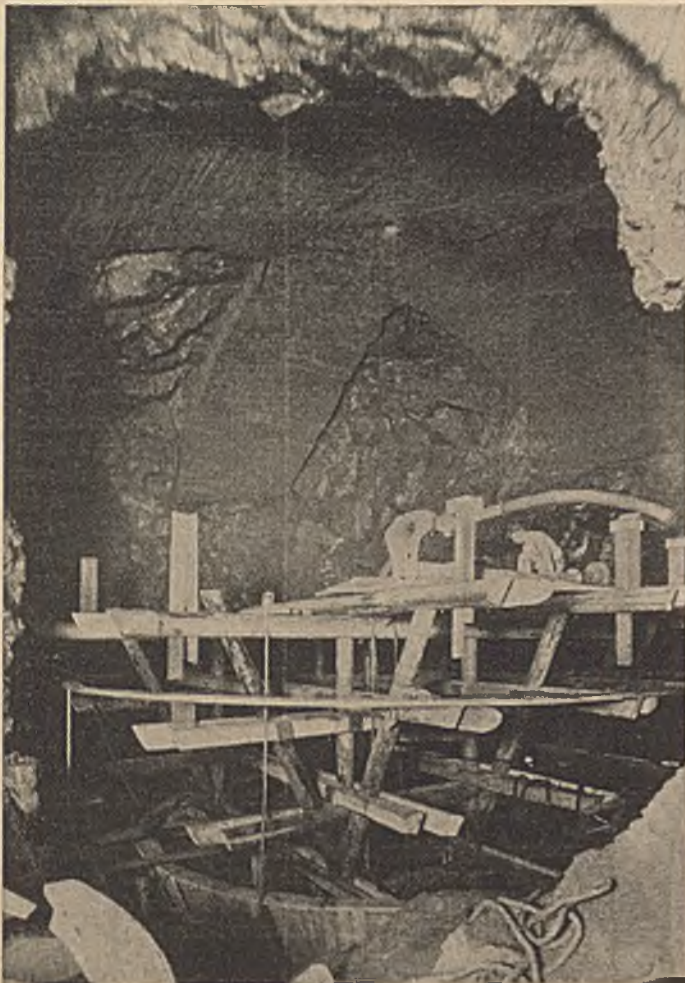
Ausbruchs- und Betonierungsvorgang des „Domes“.
